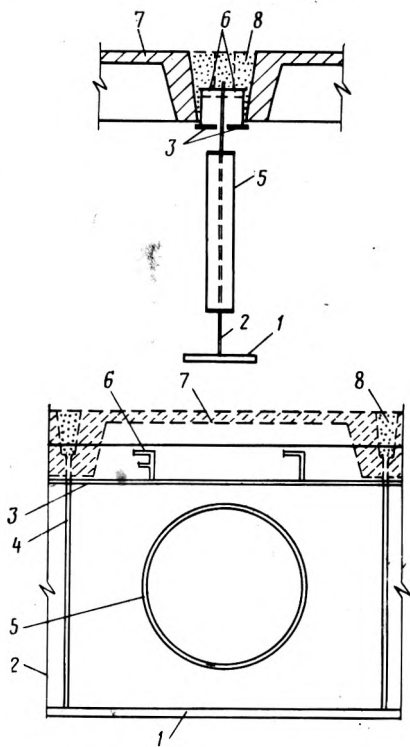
Конструктивное решение сталежелезобетонных балок перекрытий под большую временную нагрузку
